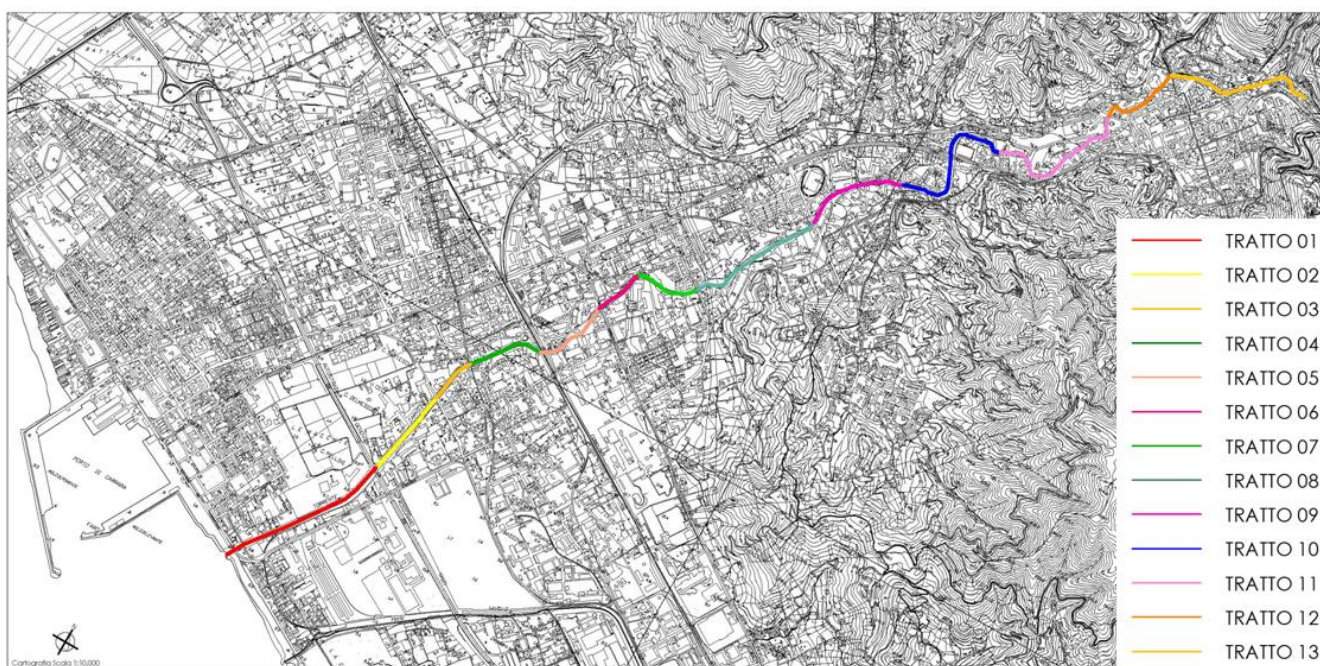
Planimetria di riferimento suddivisione in tratti del Torrente Carrione (lunghezza 8,5 km)
